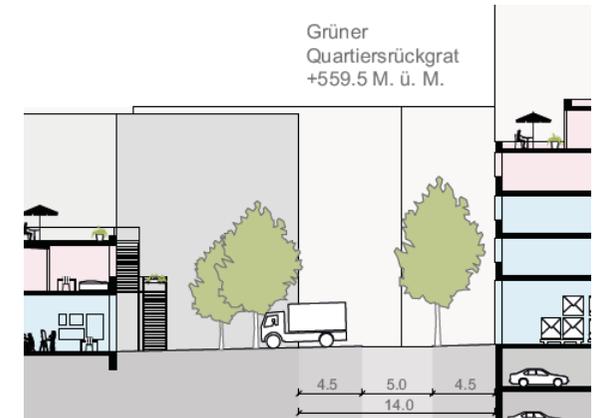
Querschnitt Dorfstrasse mit Bebauung
